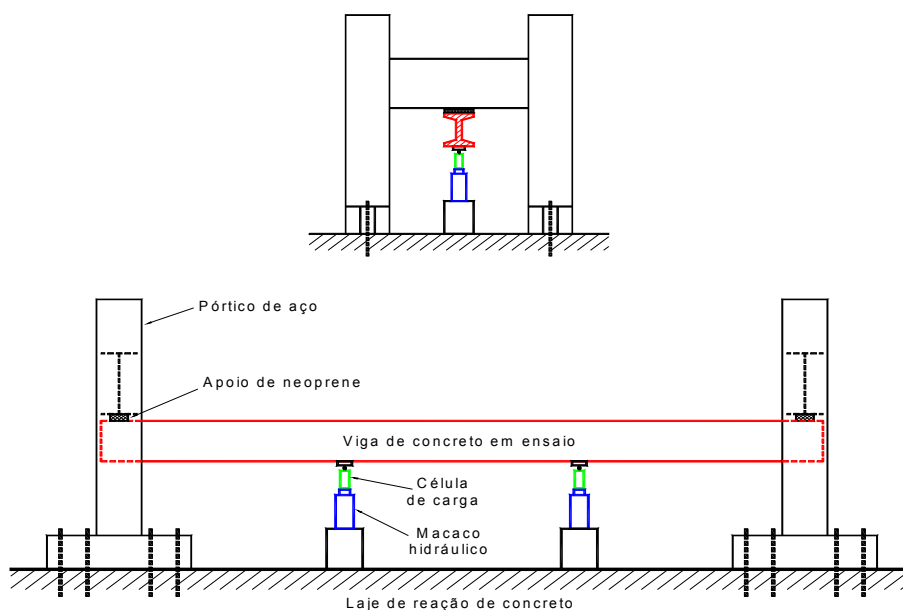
Esquema do modelo experimental de viga de concreto armado.
